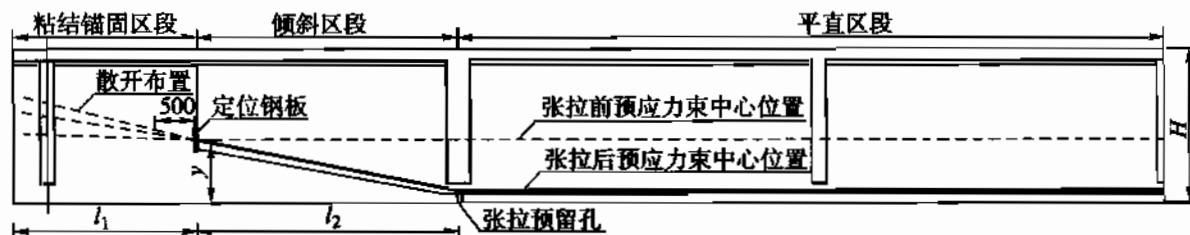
预应力束的立面布置图(尺寸单位:mm)
